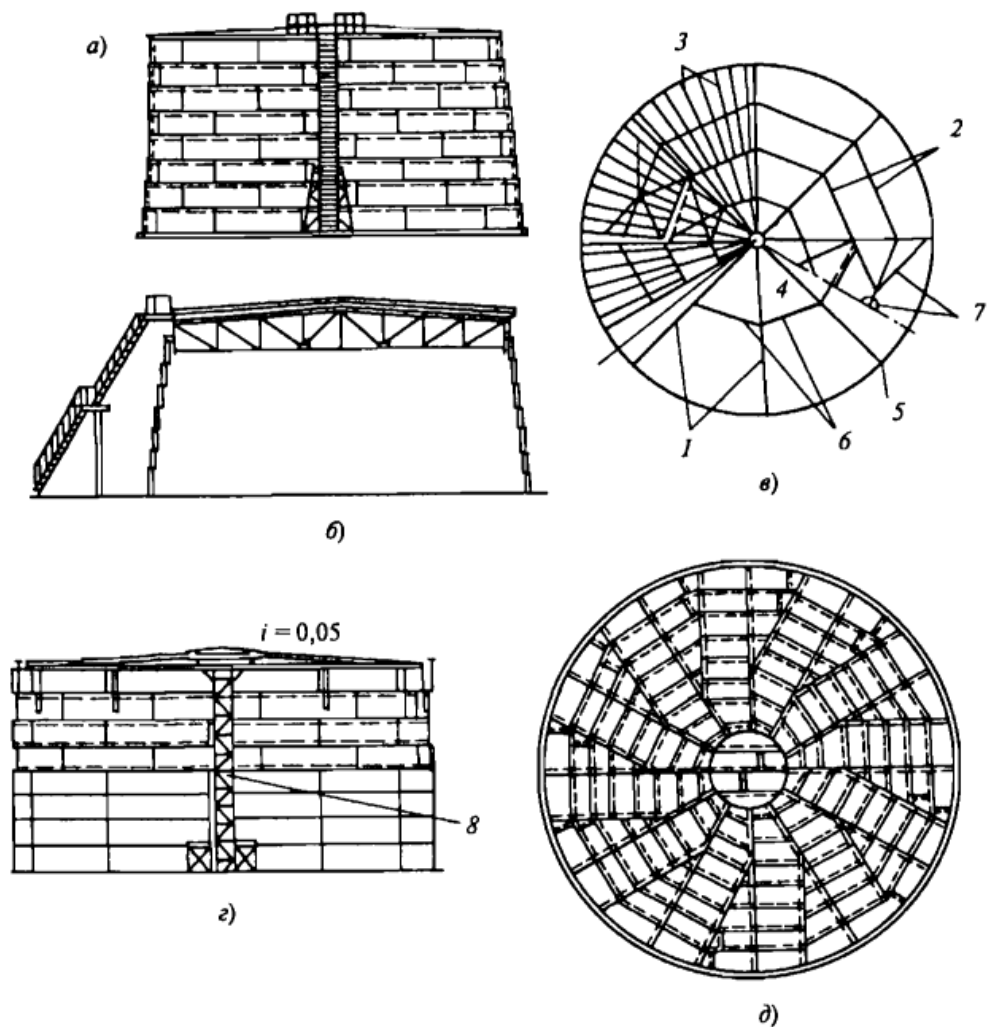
Стальные вертикальные цилиндрические резервуары
